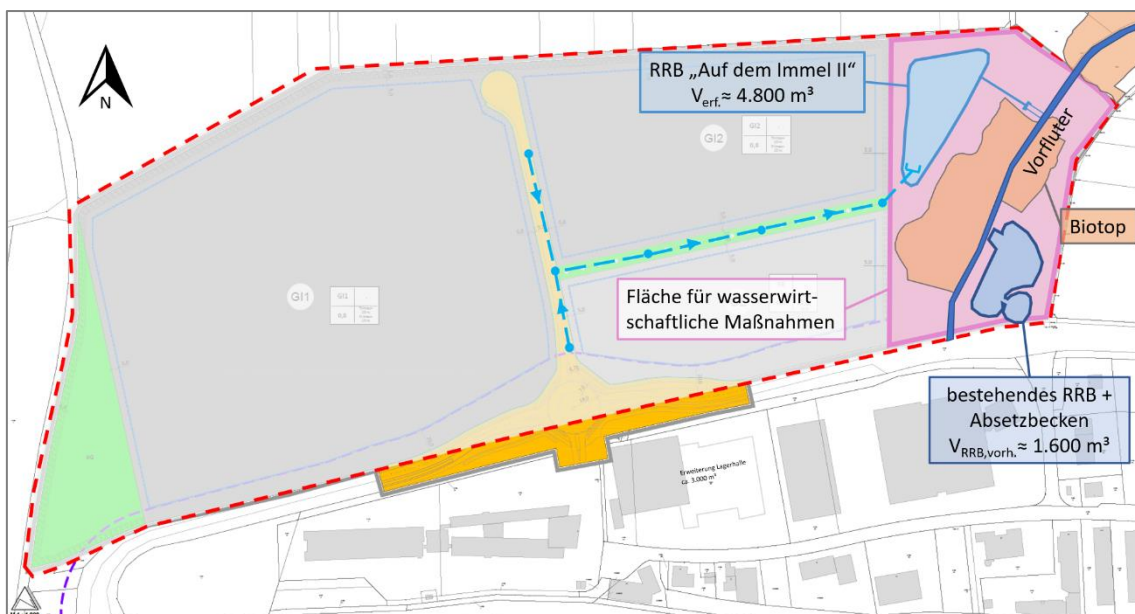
geplante Regenwasserentwässerung und Regenrückhaltung für das Plangebiet „Auf dem Immel II“
